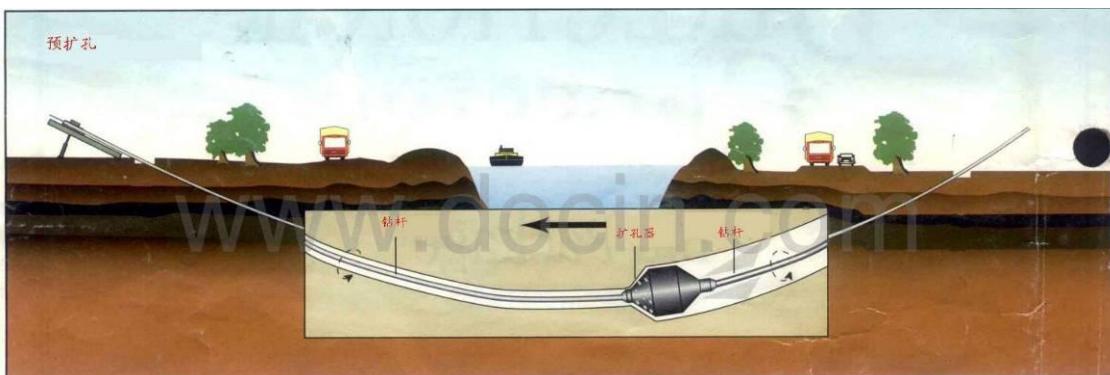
b 定向钻穿越施工预扩孔过程断面示意图
